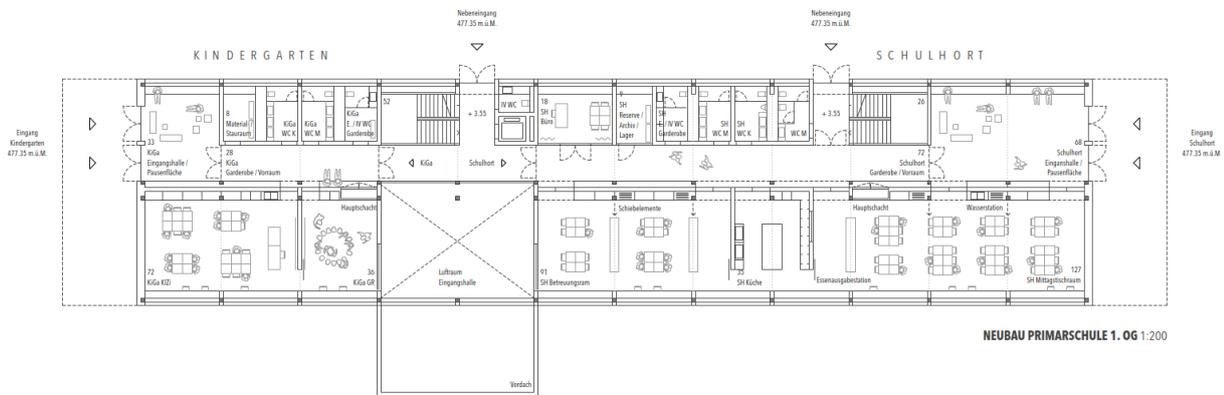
Grundriss Neubau Primarschule, 1. Obergeschoss
